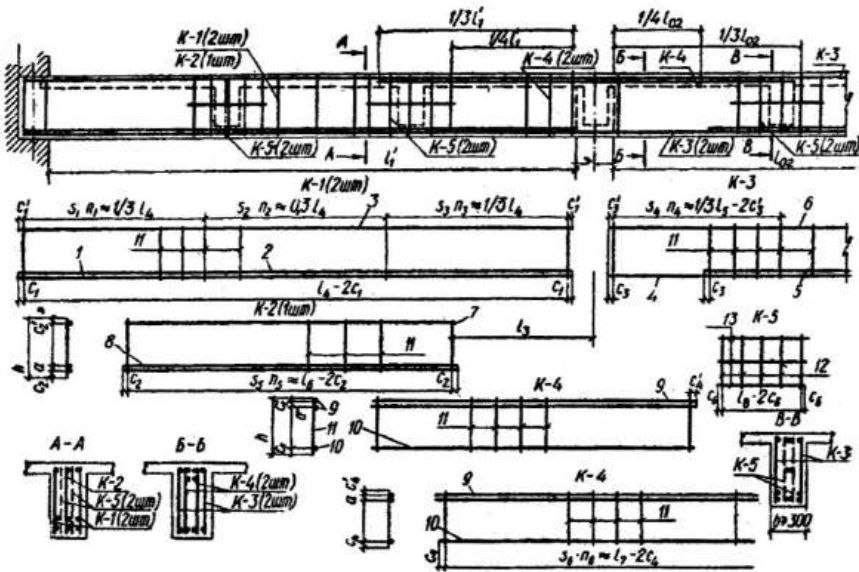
Армуння головних балок зварними каркасами: 1...13 – номери стержнів
